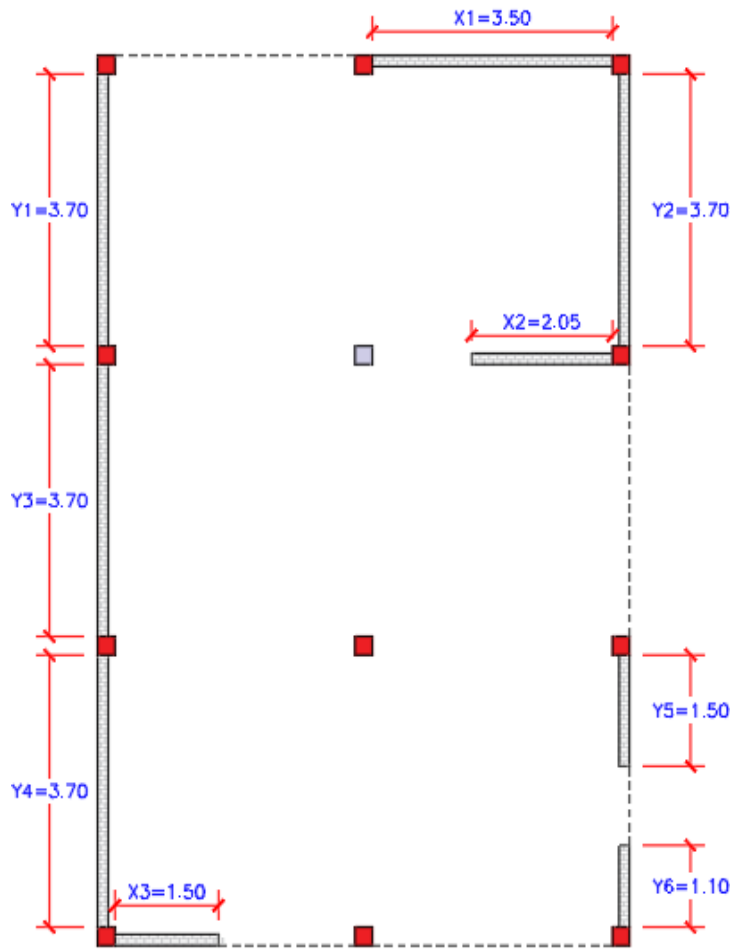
Muros portantes de Vivienda 8, vista de planta.
